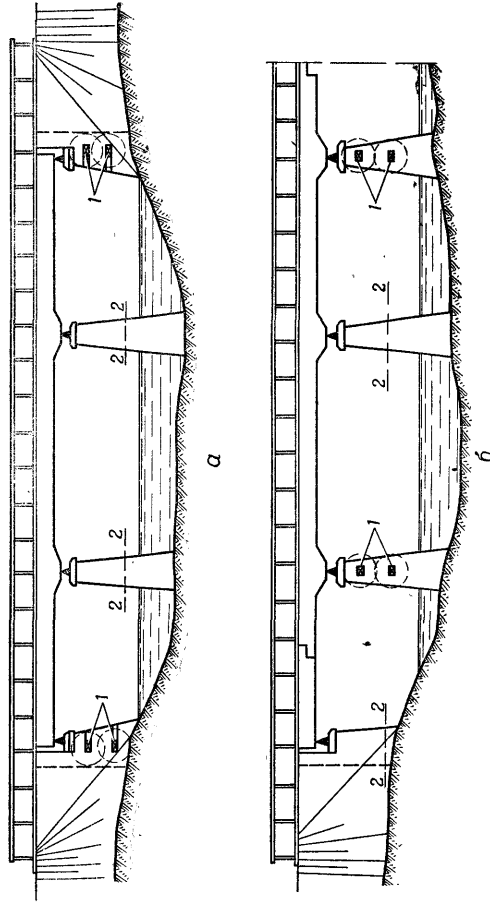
Подрывание балочных железобетонных мостов неразрезной и консольной конструкции:
